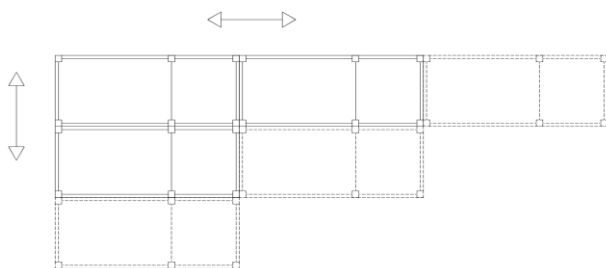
Ejemplo de geometría en paralelo de la planta de la edificación.
